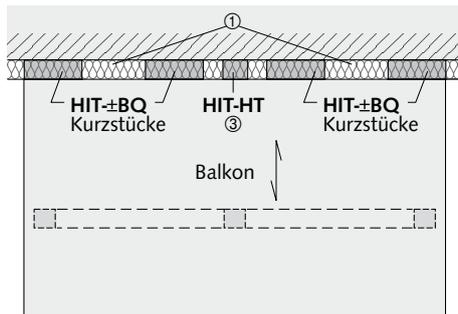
Gelenkig aufgelagerter Balkon auf Stützen. Balkonplattenanschluss mit positiven und negativen Querkräften. Evtl. Aufnahme von planmäßigen Horizontallasten durch HIT-HT Module.
